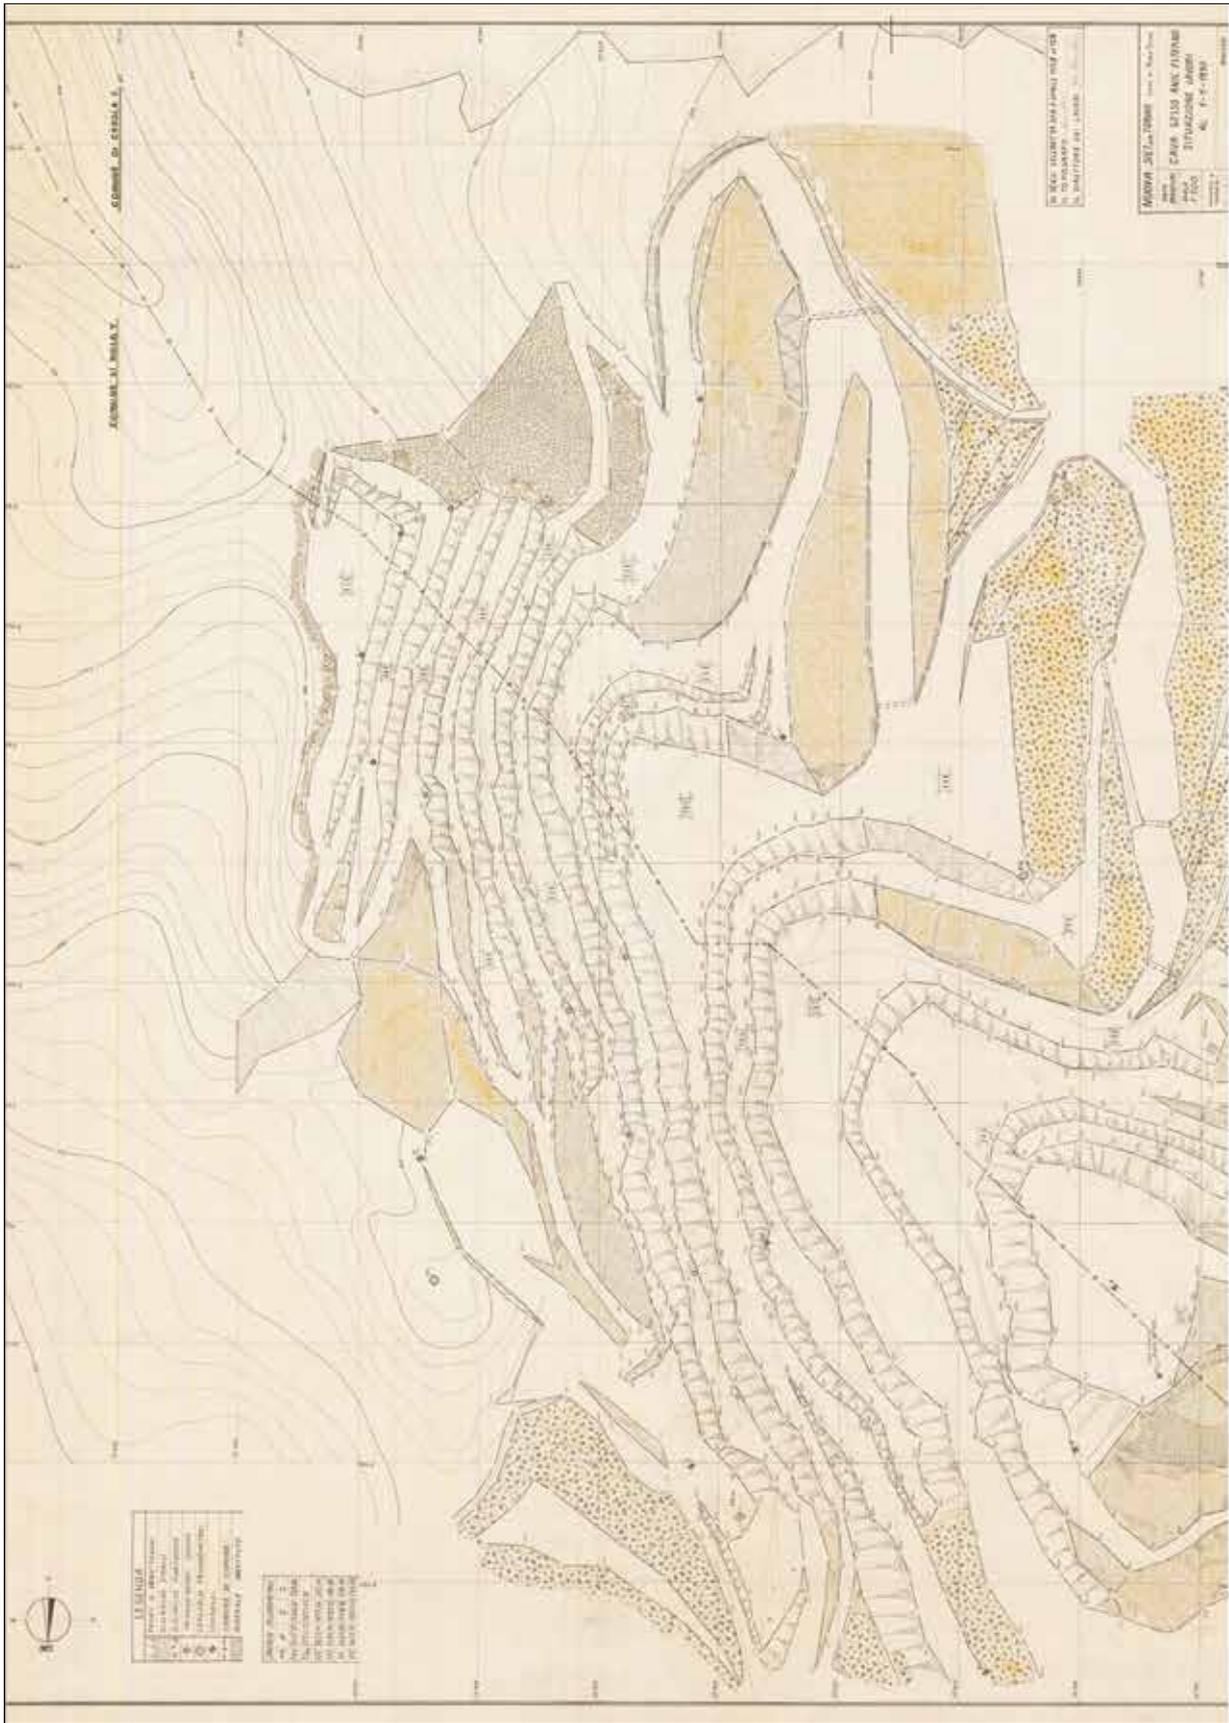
Cava di Monte Tondo. Pianta lavori in esterno al 1 gennaio 1990 (Archivio Adelio Olivier).
